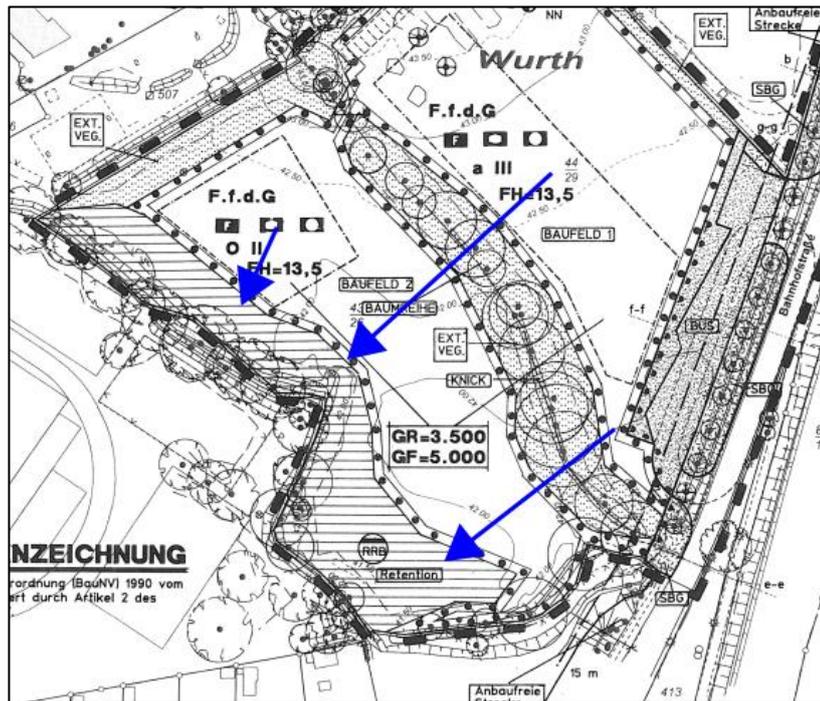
Planzeichnung mit möglicher Wasserführung (Quelle: ML-Planung, modifiziert)
